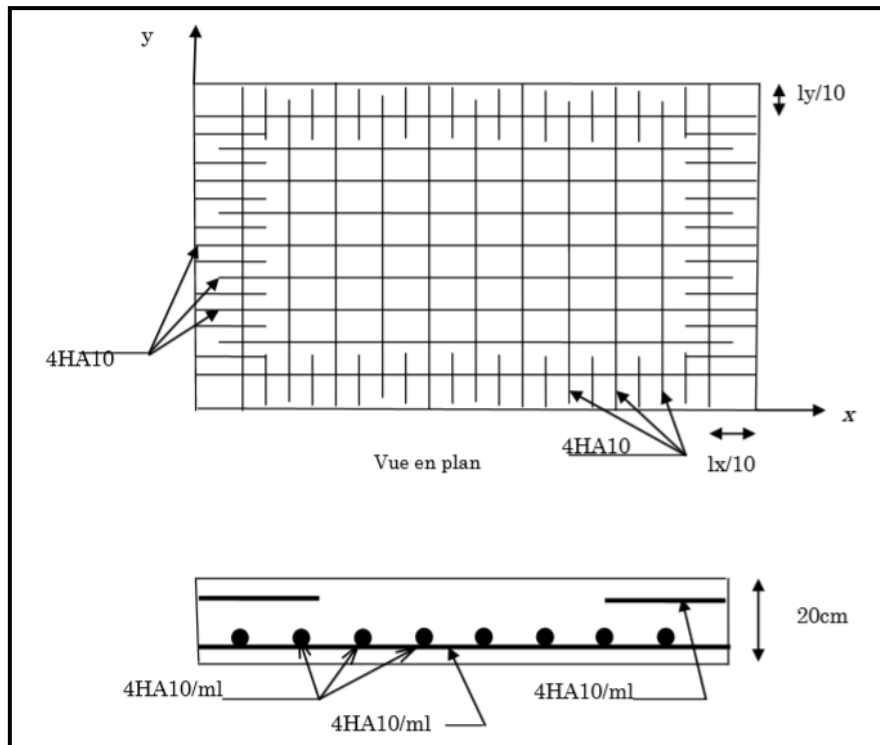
Ferrailage de la dalle de l'ascenseur.
